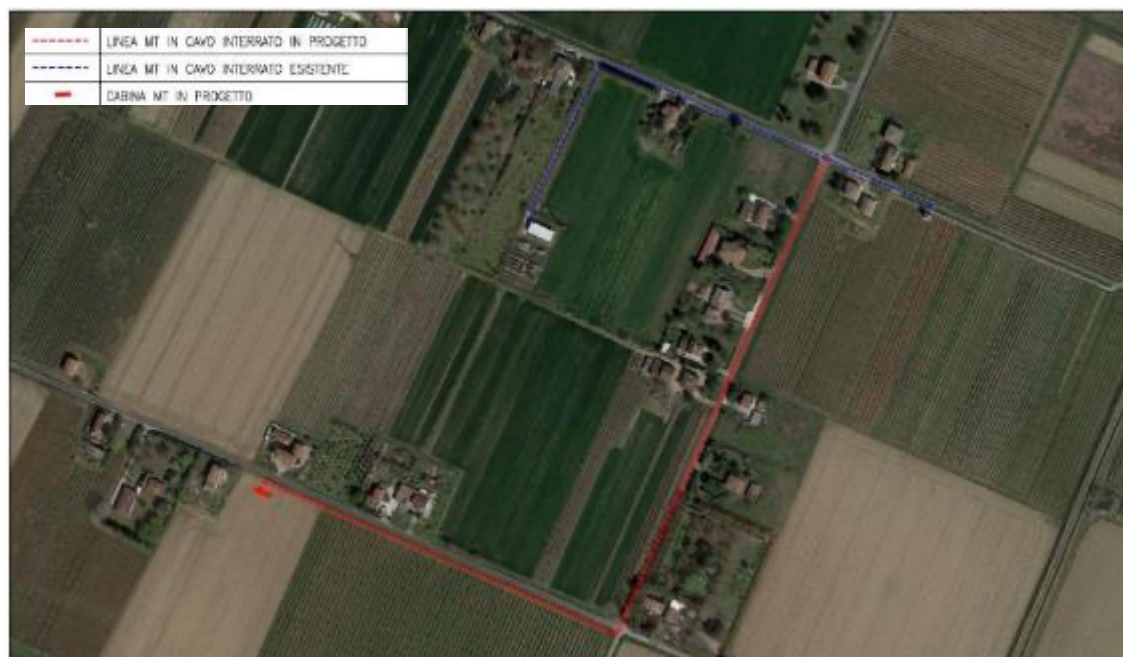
Estratto planimetria di progetto dell'impianto di connessione: linee MT e cabine MT
